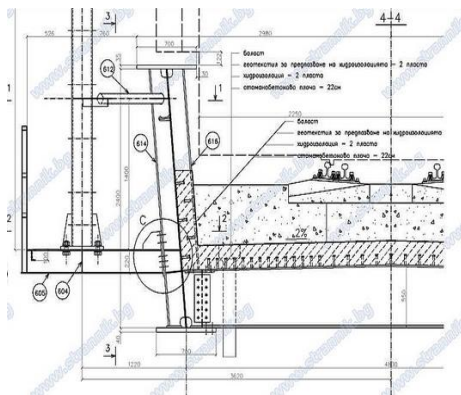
Водоотвеждане и хидроизолиране под тротоар с монтаж Г-образен корниз
